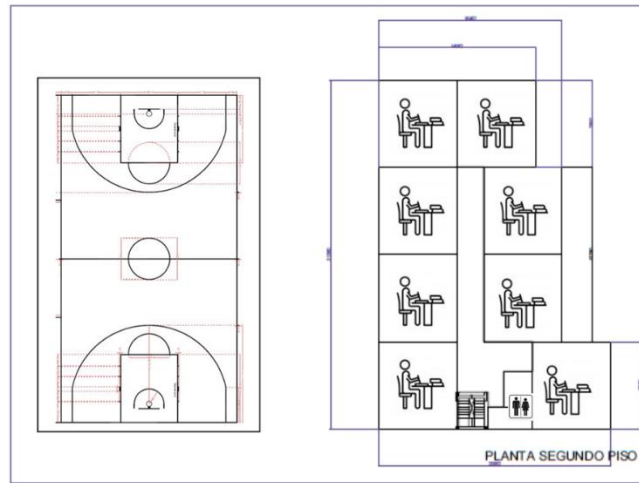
Planta 1 y 2 establecimiento escolar proyectado (preliminar para cálculo de superficies)
